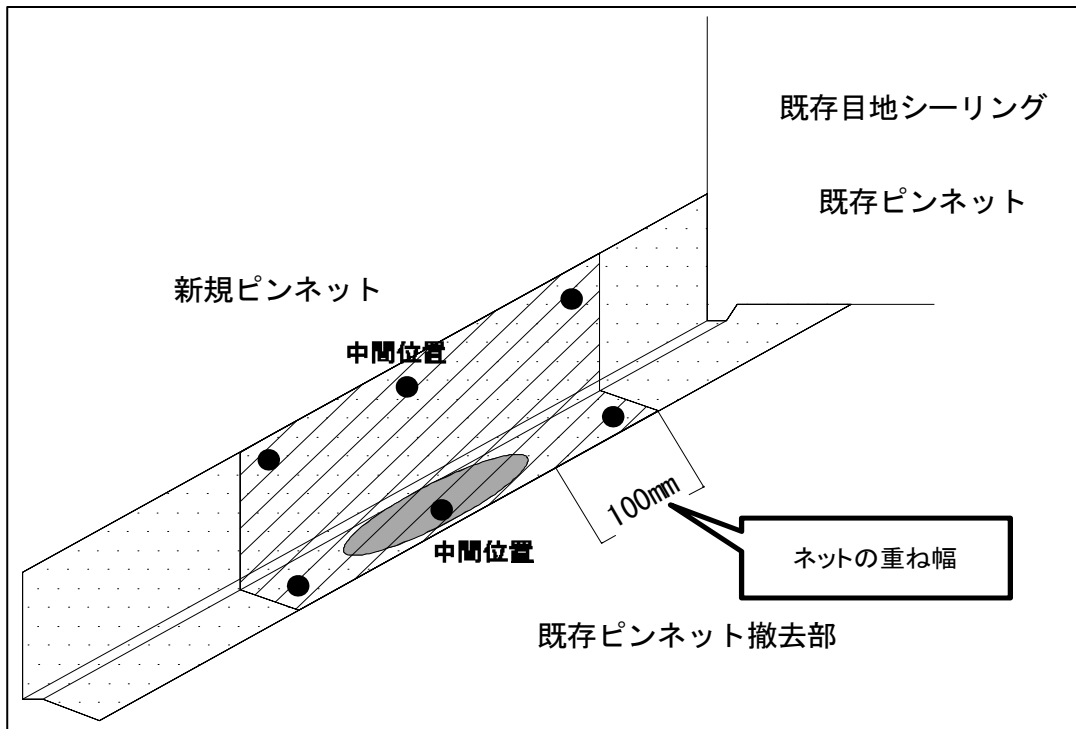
アンカーピン施工位置 (ネット幅 600mm 以上 1000mm 未満の場合)
